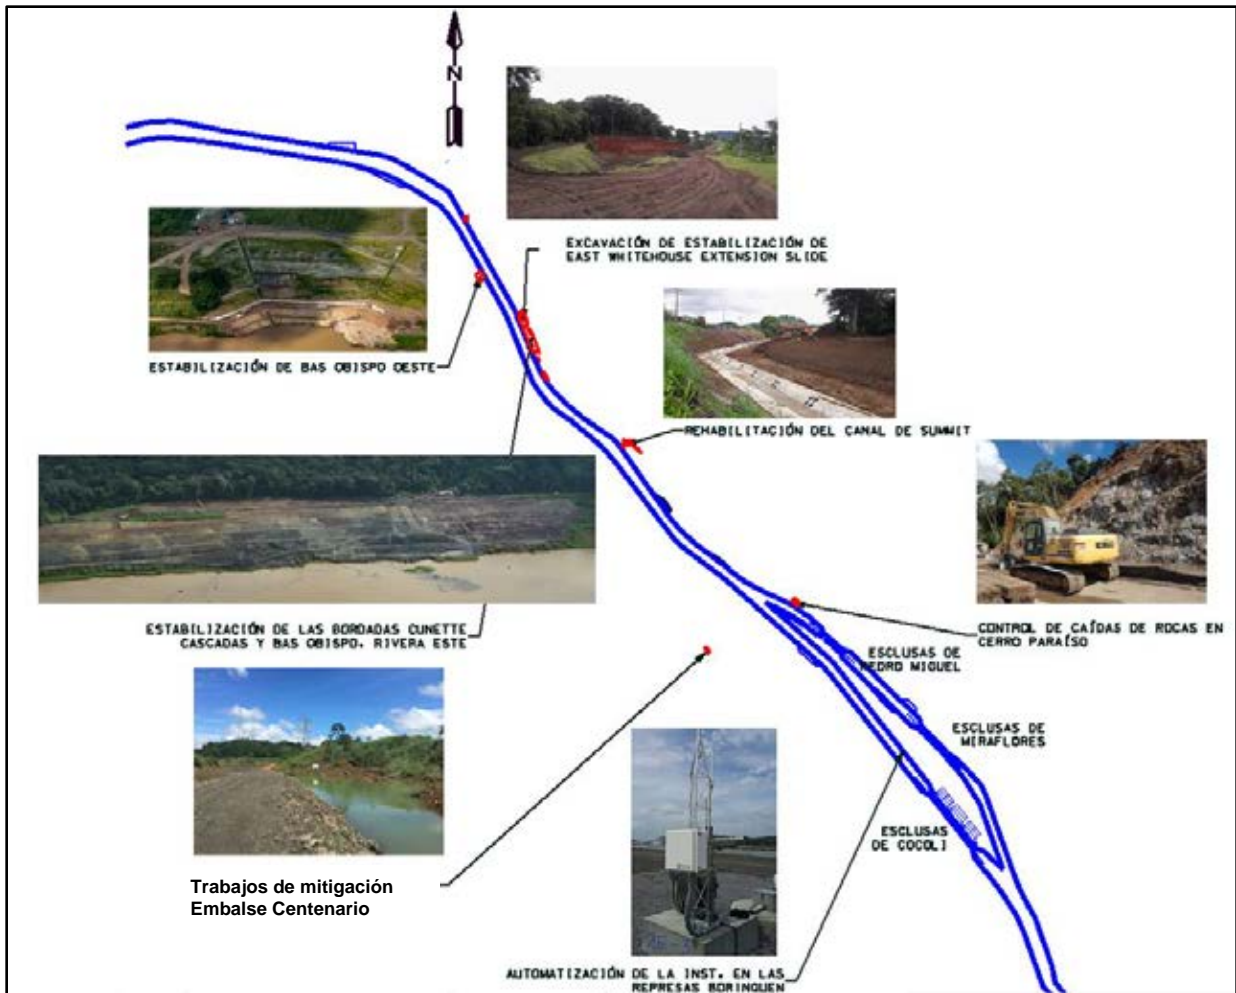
Vista de planta de proyectos ejecutados en el año fiscal 2018
